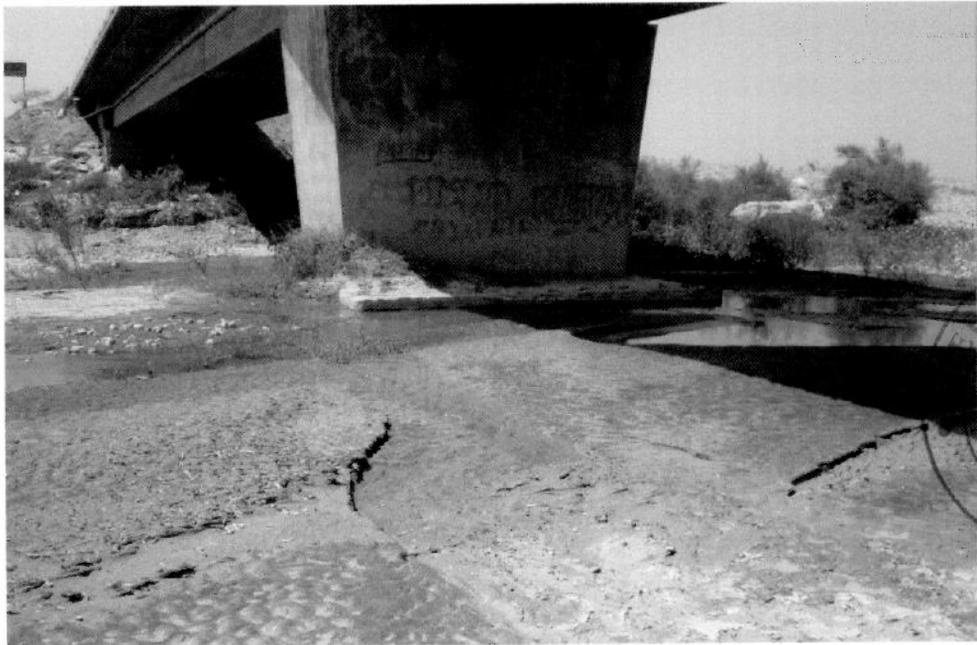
Puente Careaga: Se observa socavación en los pilares. Requiere obras de defensa en el lecho.
